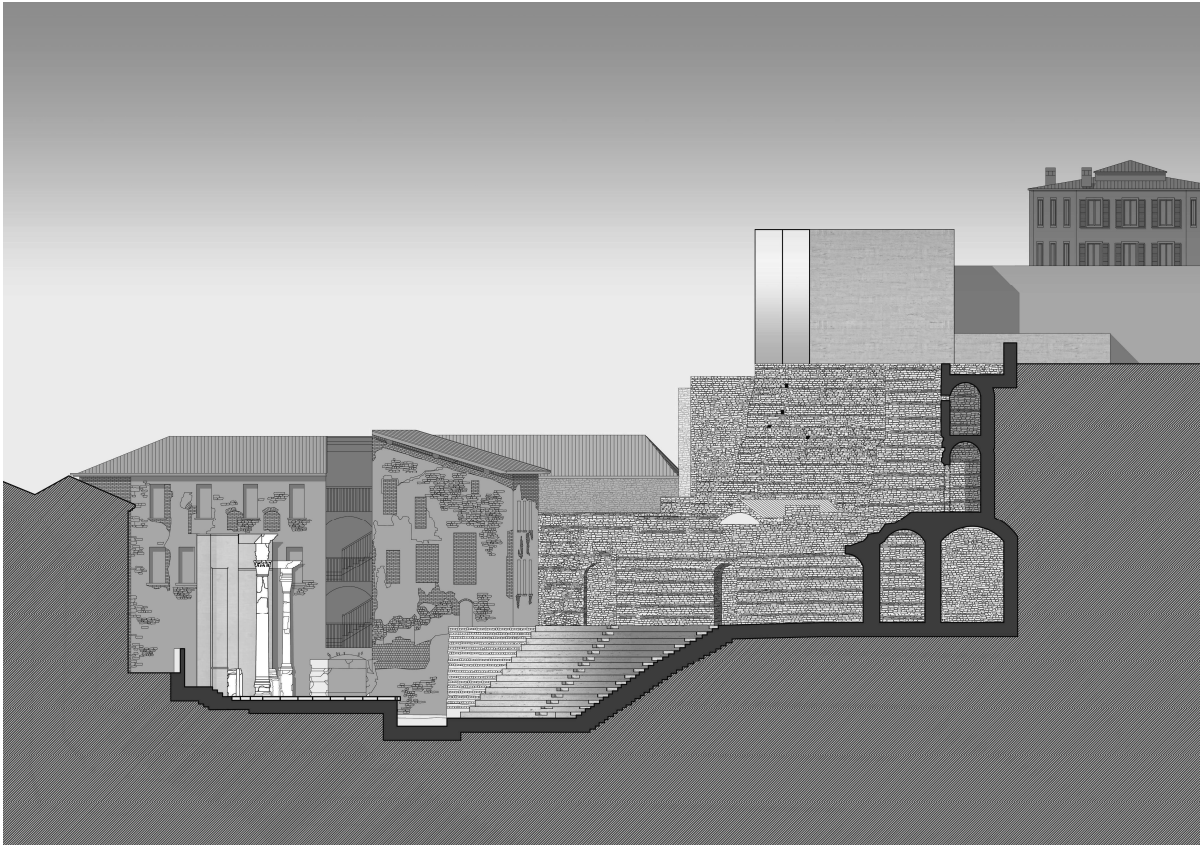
Progetto: Sezione del Teatro Ovest.
